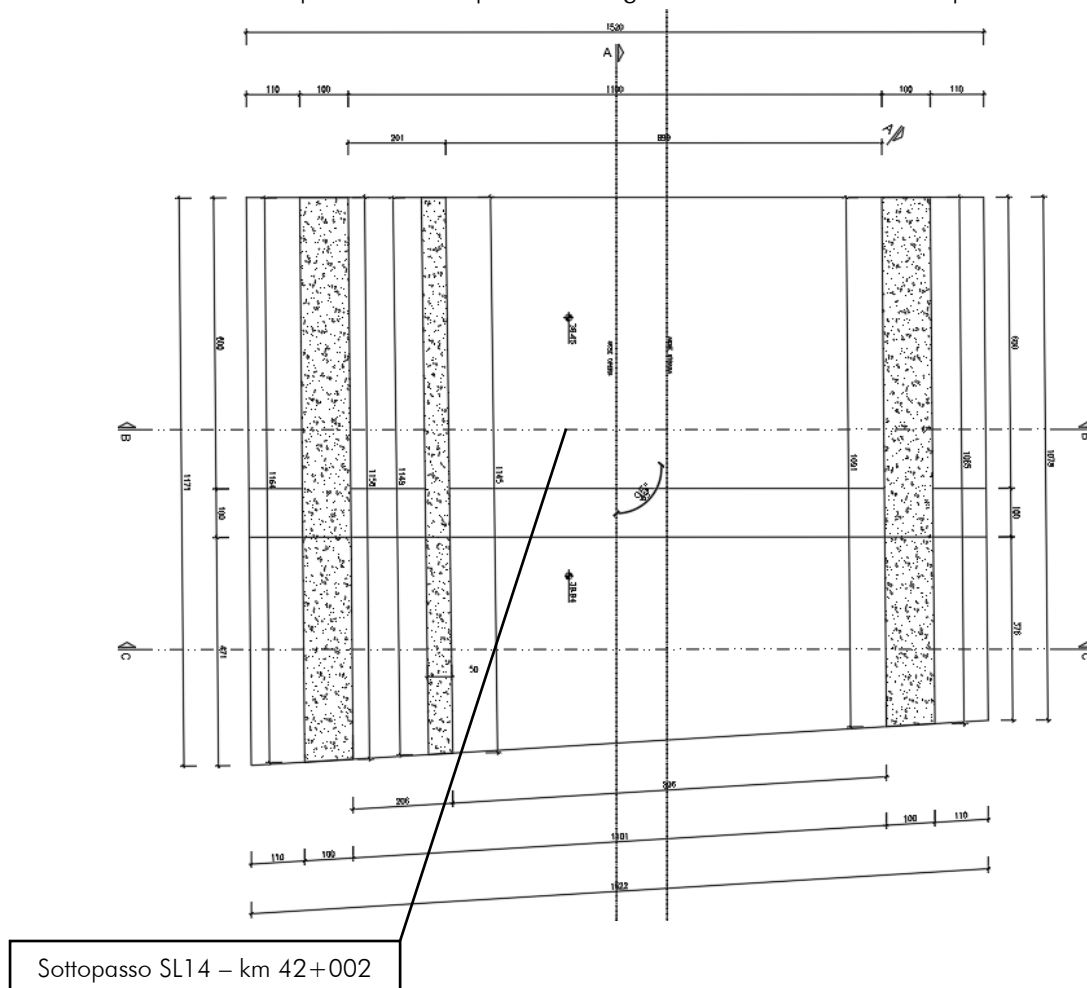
Stralcio planimetrico – Ubicazione sottopasso SL14
